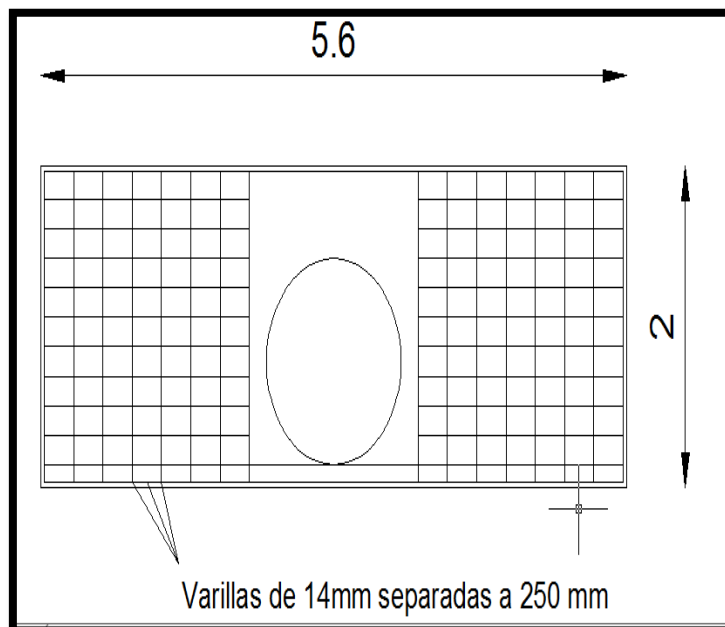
Elevación frontal del cabezal para alcantarillas de 1400mm.
